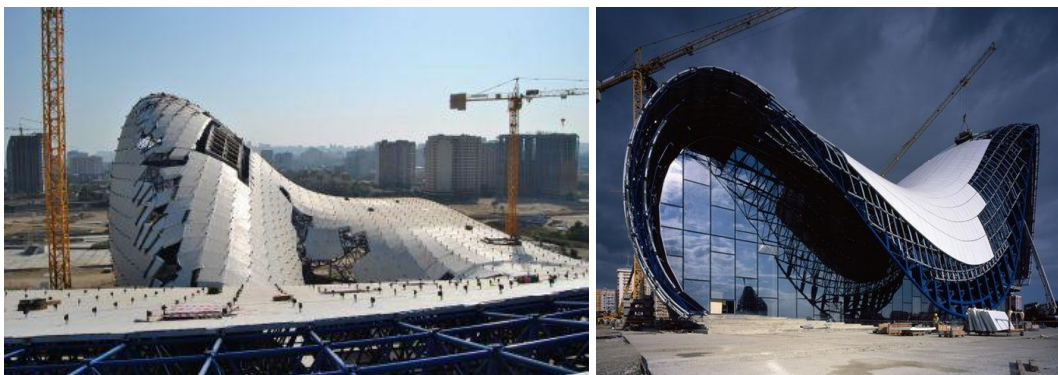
revêtement de la structure tridimensionnelle, centre culturel, Zaha Hadid.
